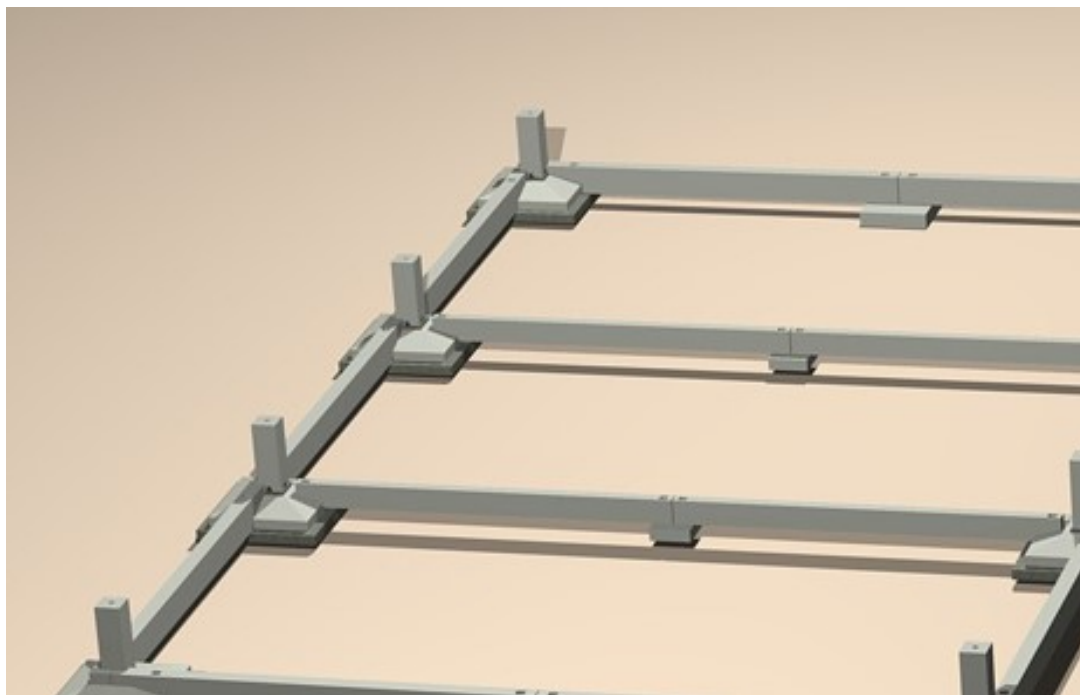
Esempio di fondazione prefabbricata. Fonte "Travi Sud".
